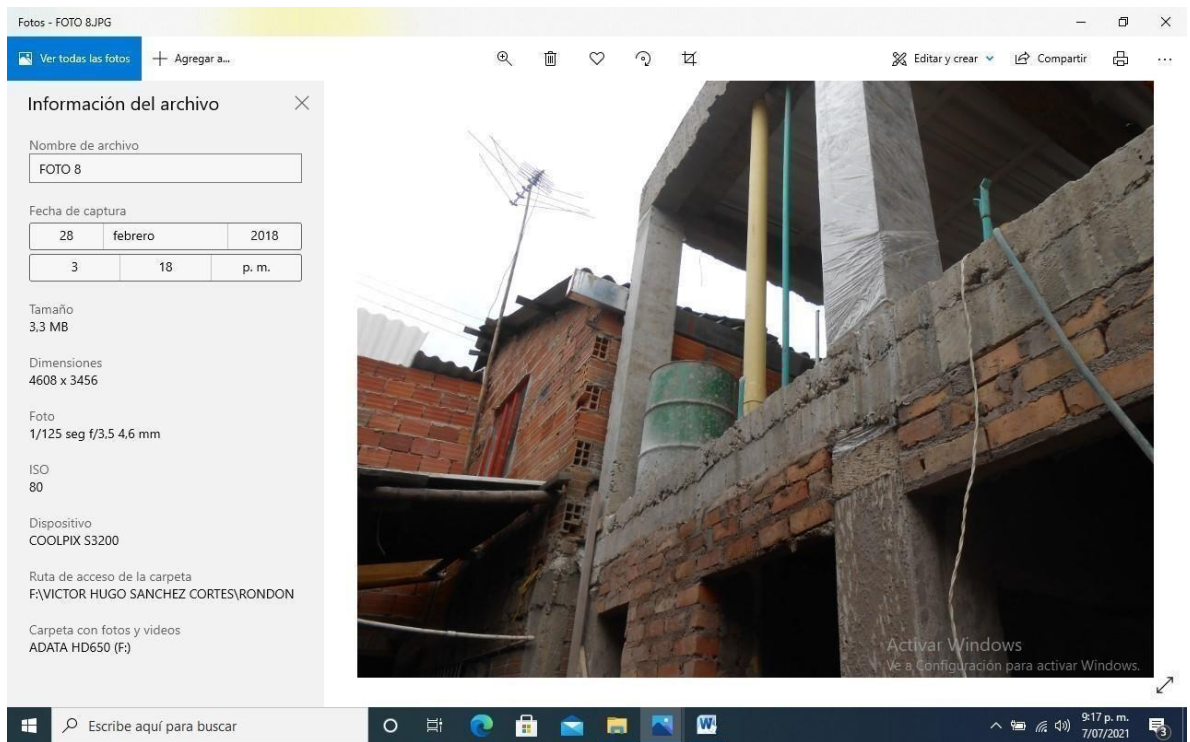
Vista canaleta para evitar caída de aguas lluvias a las dos edificaciones.
